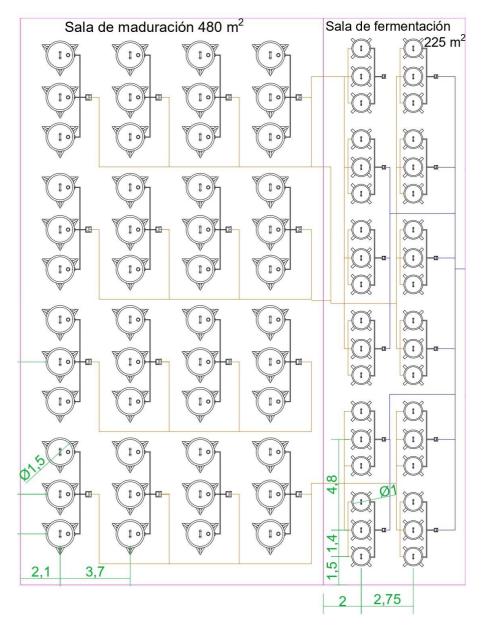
Layout salas de fermentación y de maduración (cotas en metros)
